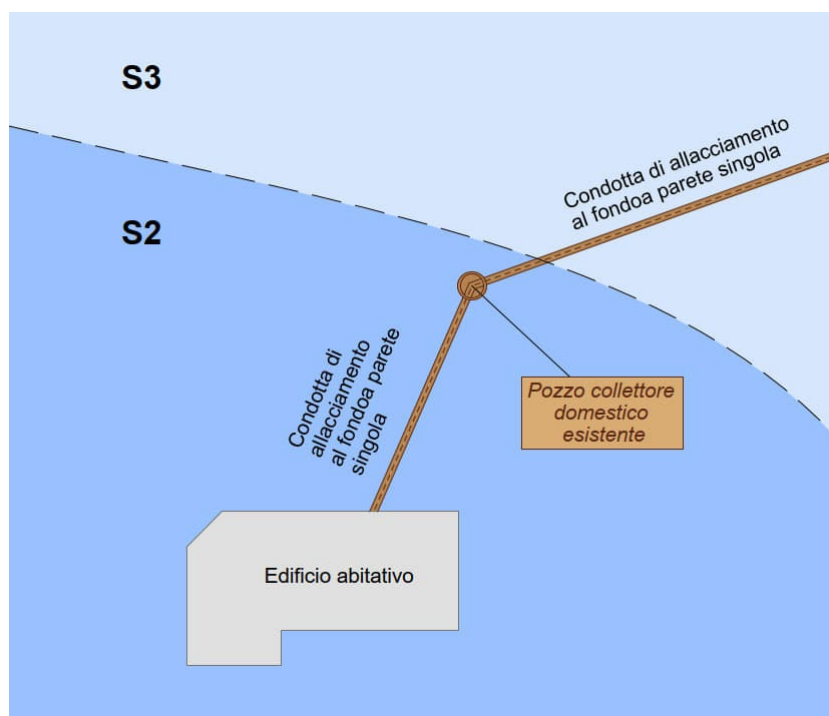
situazione iniziale condotta di allacciamento del fondo con esecuzione standard
